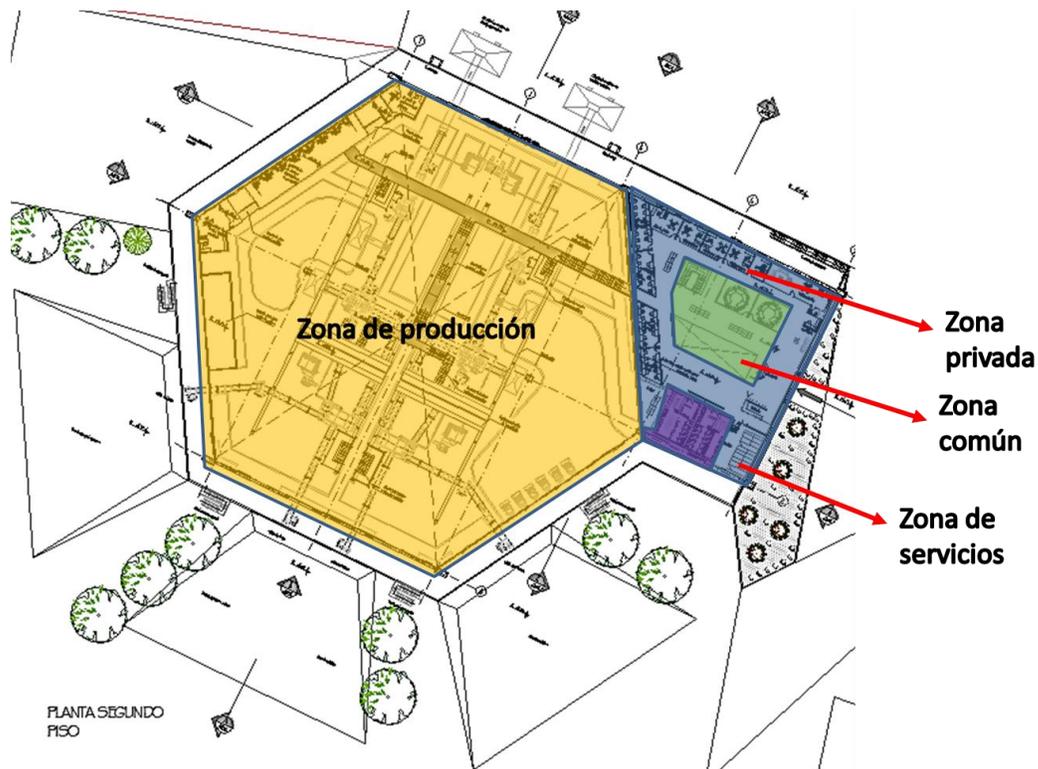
Zonificación en primer piso de la planta de tratamiento de escombros. (Fuente: elaboración propia)
